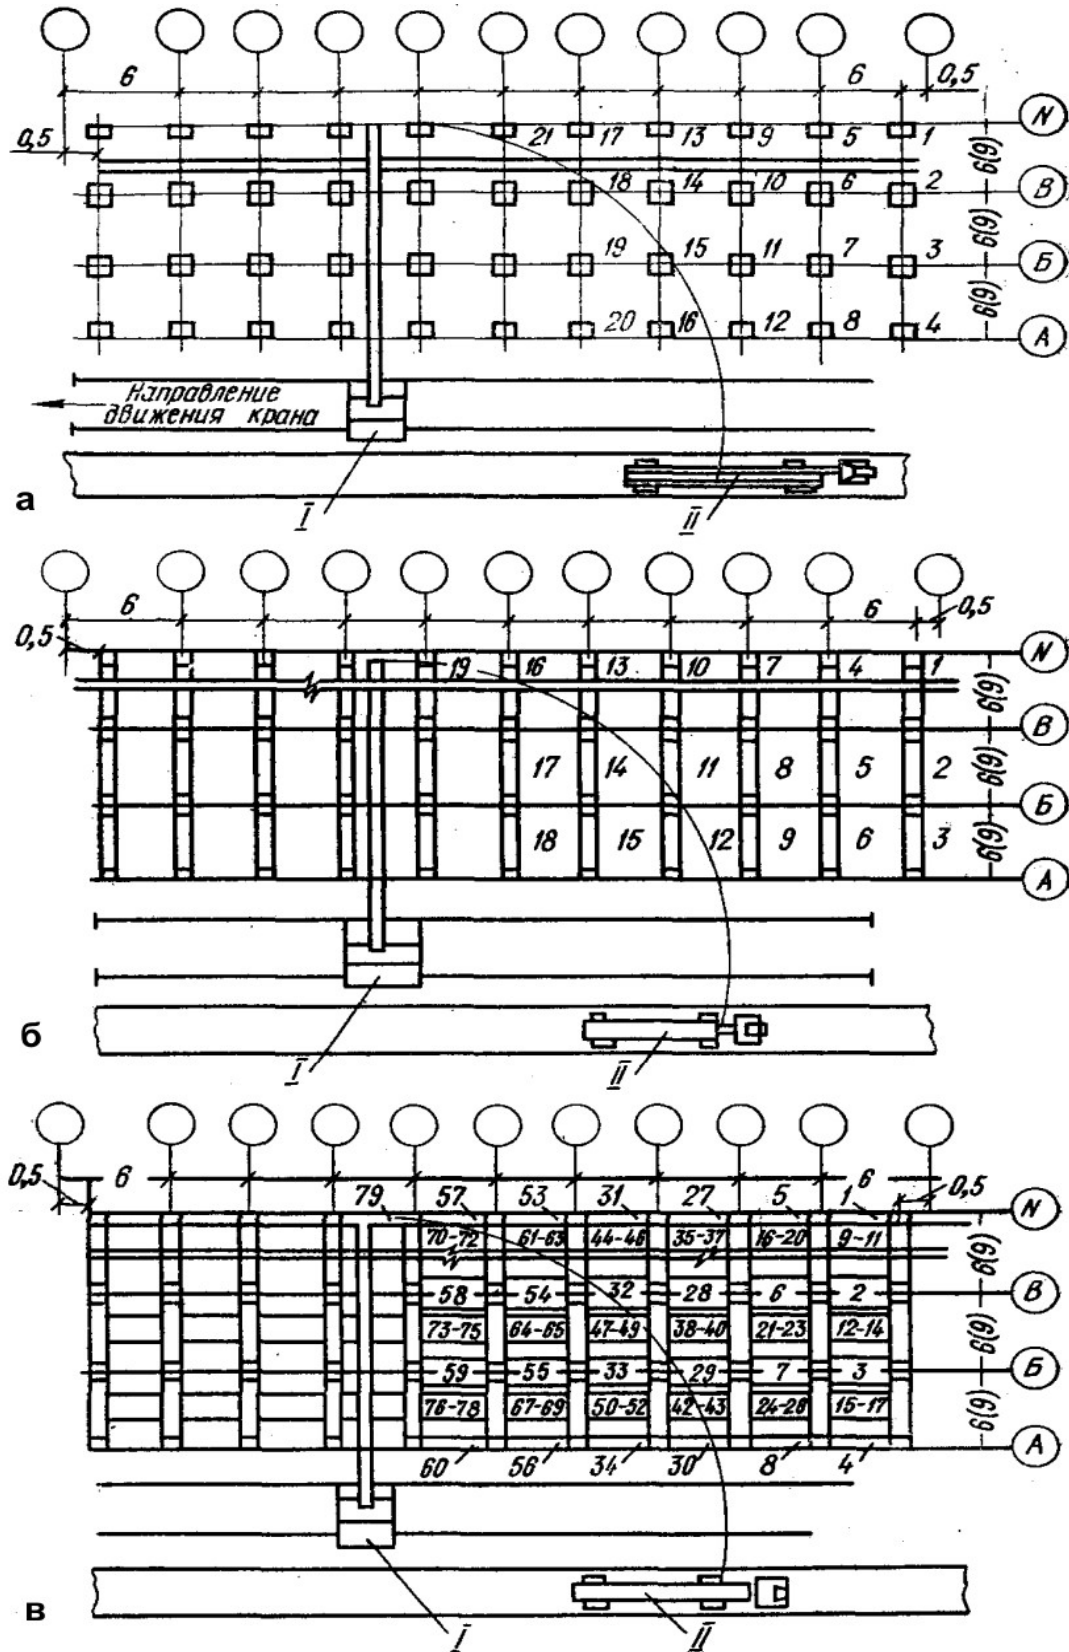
Схема монтажу каркасу з розташуванням баштового крана з однієї сторони будівлі: а — монтаж колон; б — монтаж ригелів; в — монтаж плит перекриття; I — баштовий кран; II — транспортний засіб; 1,2,3... — послідовність монтажу елементів
